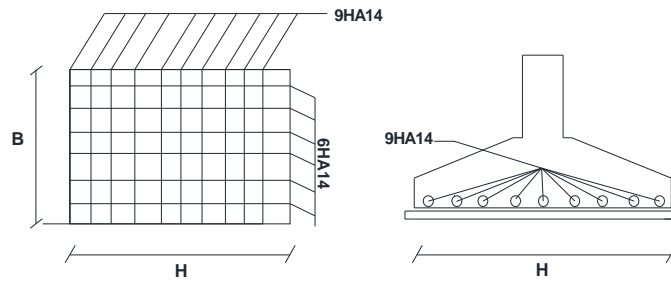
Schéma de ferrailage de la semelle de poteau.
